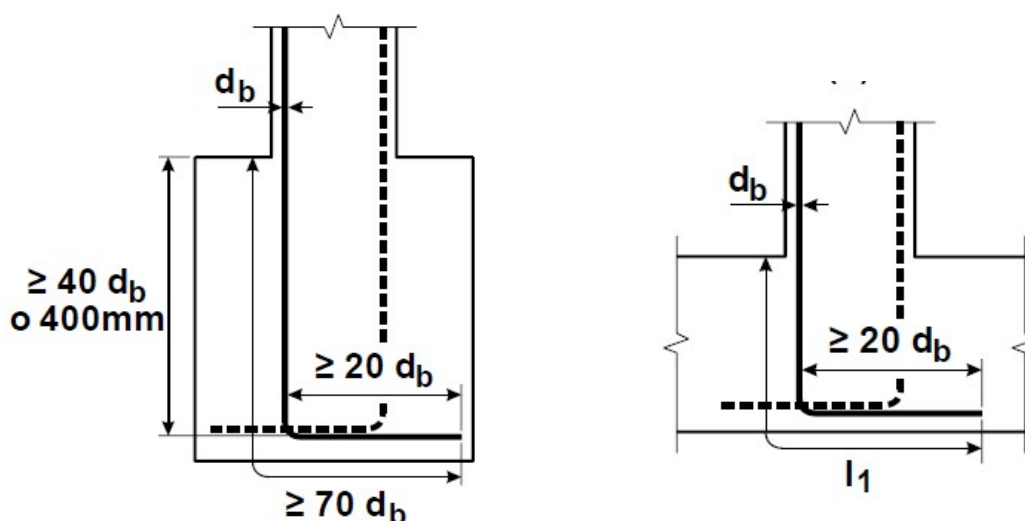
Detalles de anclajes del encadenado vertical y encadenado horizontal inferior (en fundación) CIRSOC 103
